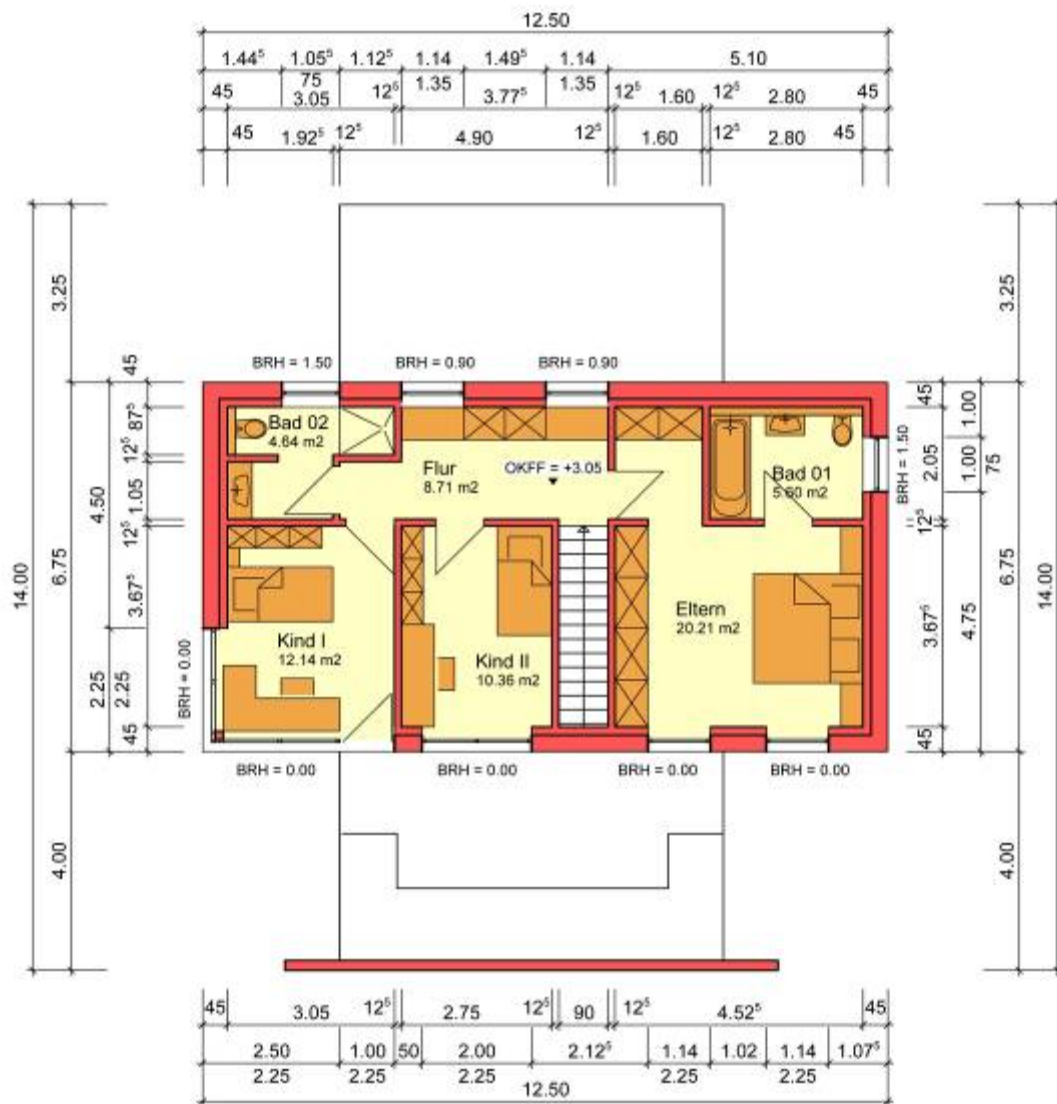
Obergeschoss Haustyp B (unmaßstäblich) Hillebrand und Welp
